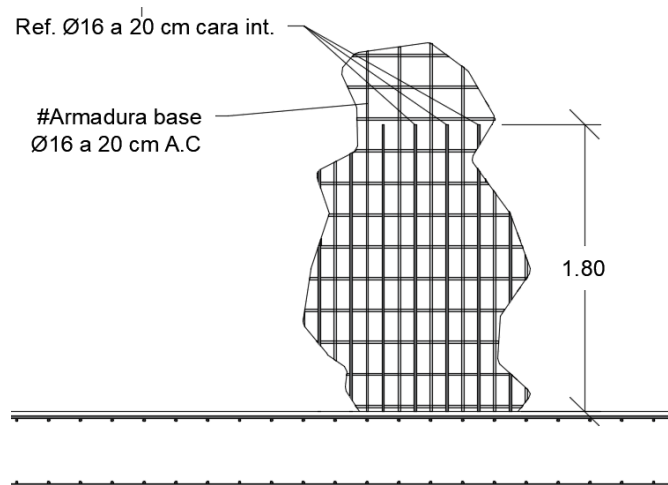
Refuerzo sobre armadura base en Muros Externos 4 y 7 (armadura vertical)
